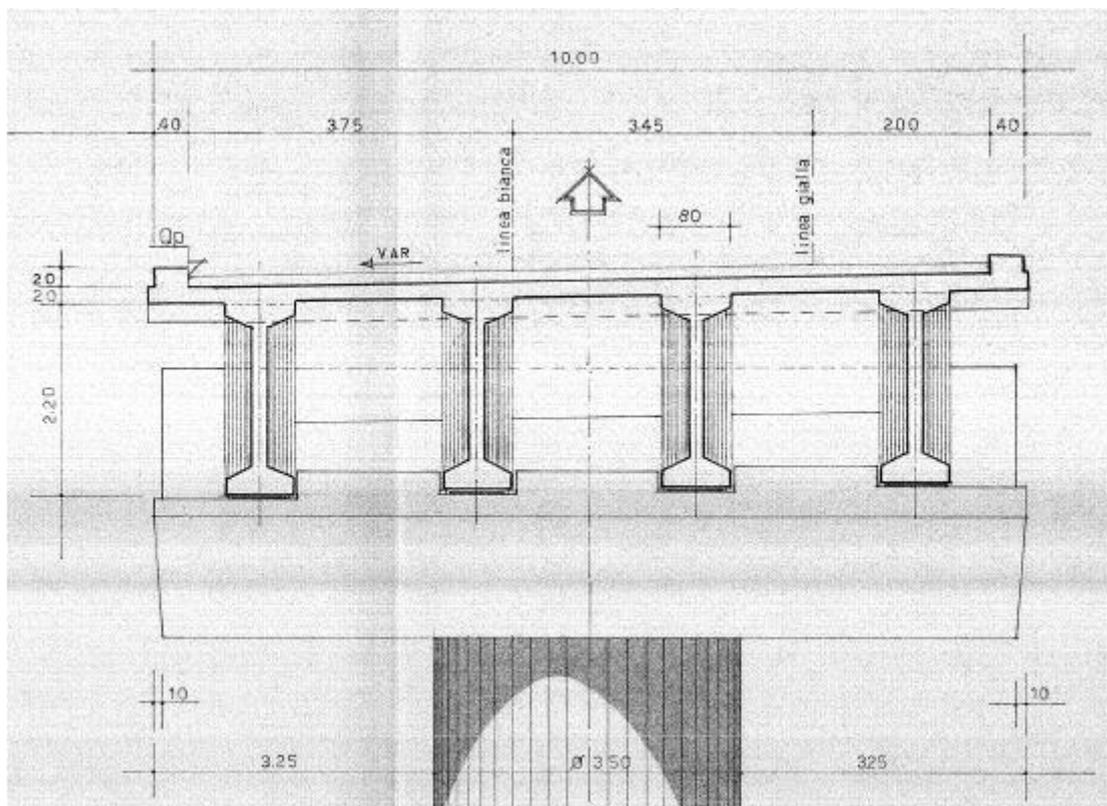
Impalcato a 4 travi in CAP – Sezione trasversale in curva
